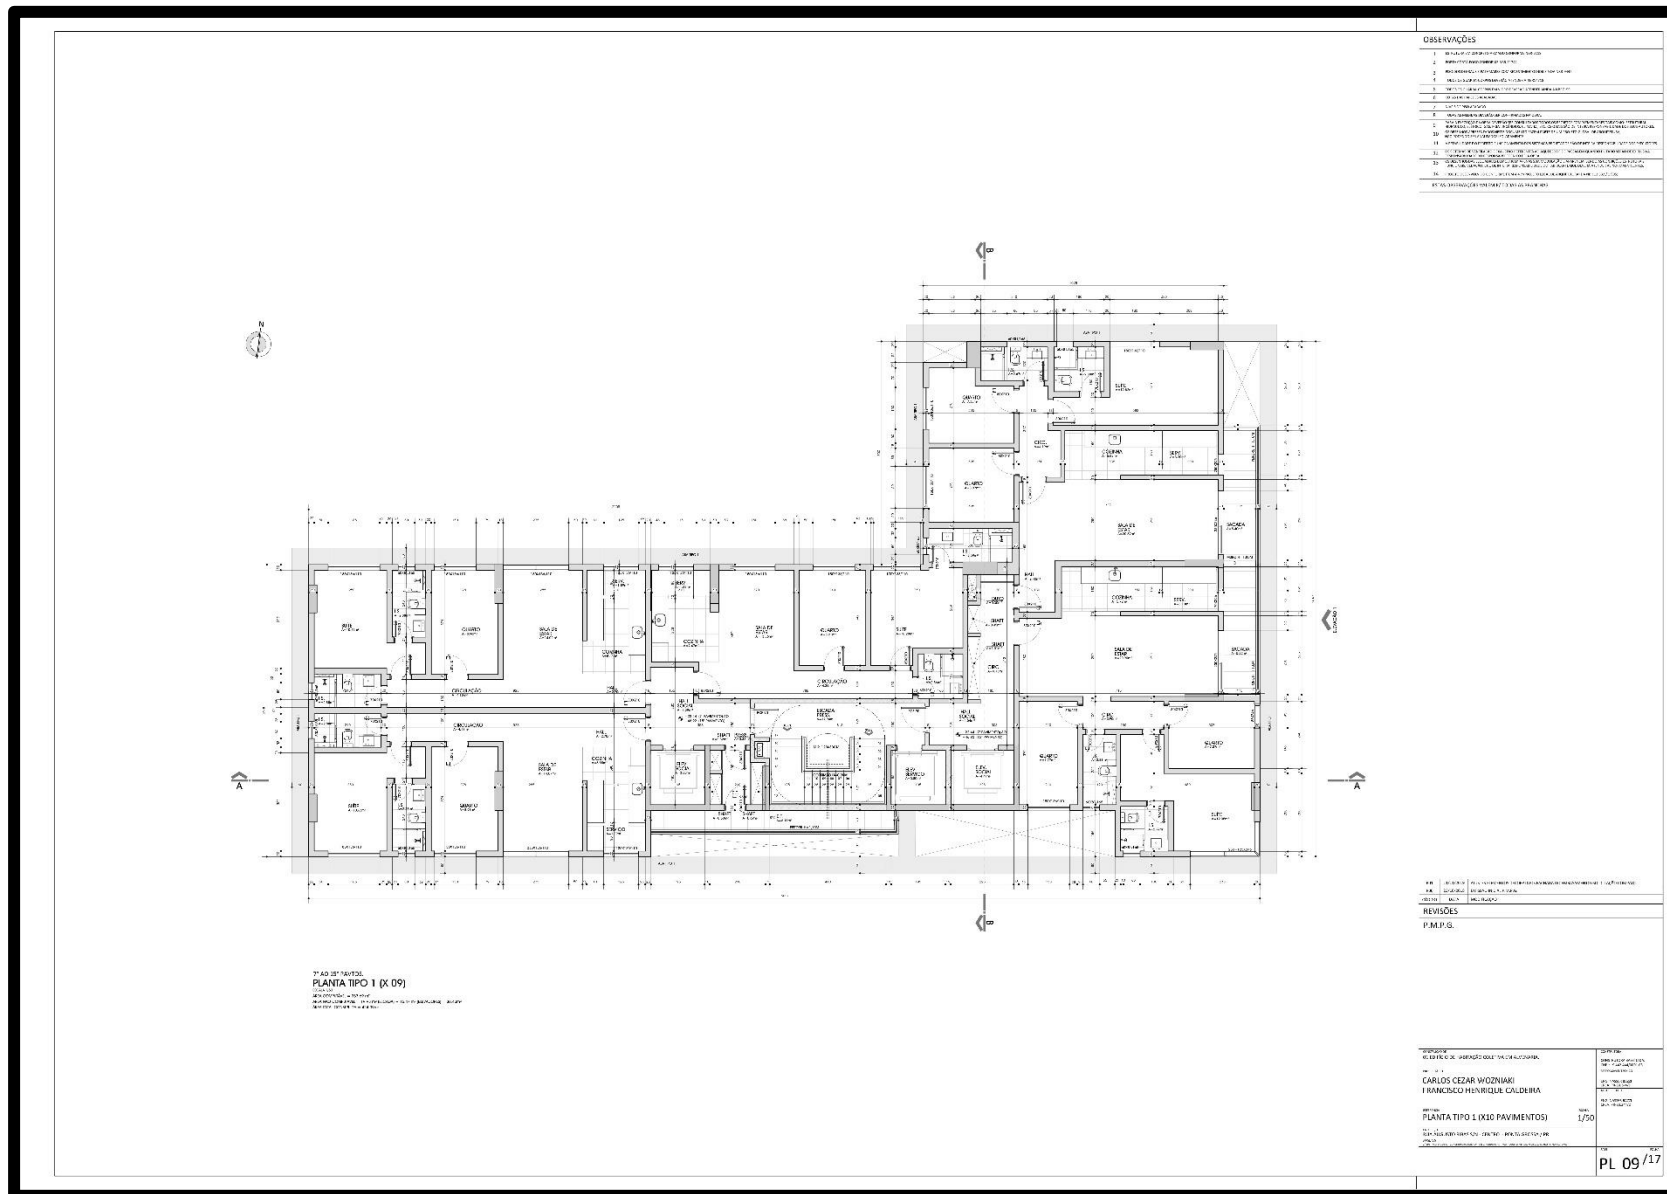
Planta tipo 1 (x9 – do sétimo ao décimo quinto pavimento) . Fonte: Construtora Bazzi (2020).
